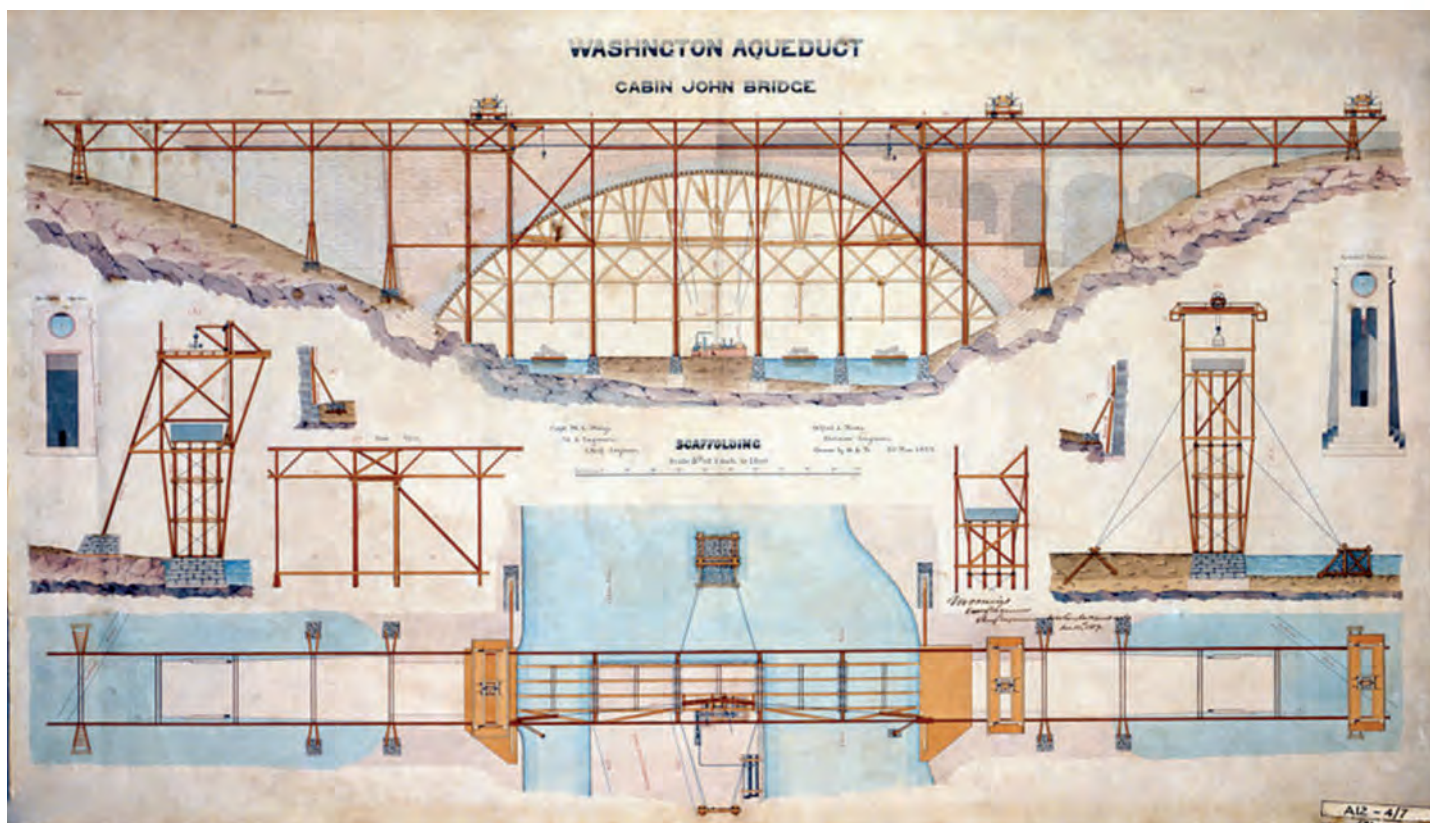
Schița de proiect pentru construcția eșafodajului podului-apeduct Cabin John Bridge
